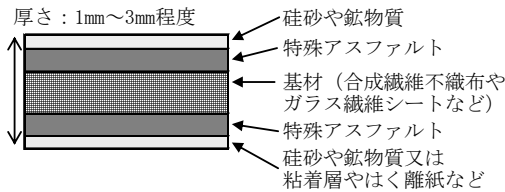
ひび割れ抑制シートの断面概要図
